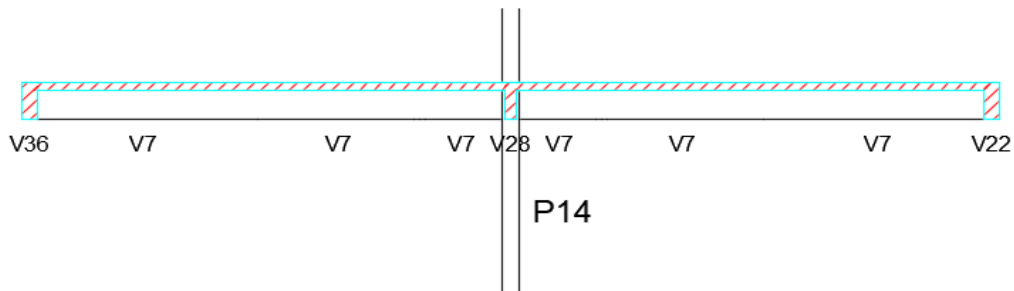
Detalhamento da viga 4 e dimensões (em cm) em temperatura ambiente
